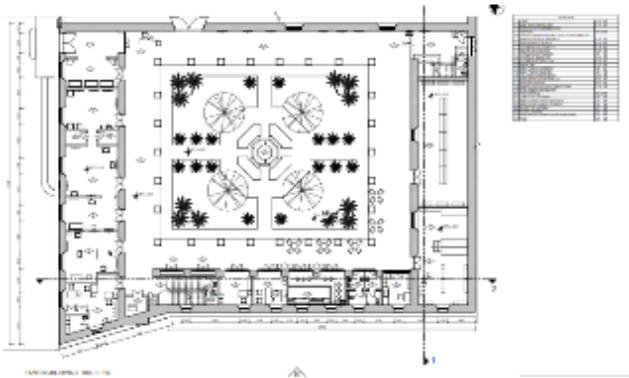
Plantas arquitectónicas propuestas por niveles. (3)
